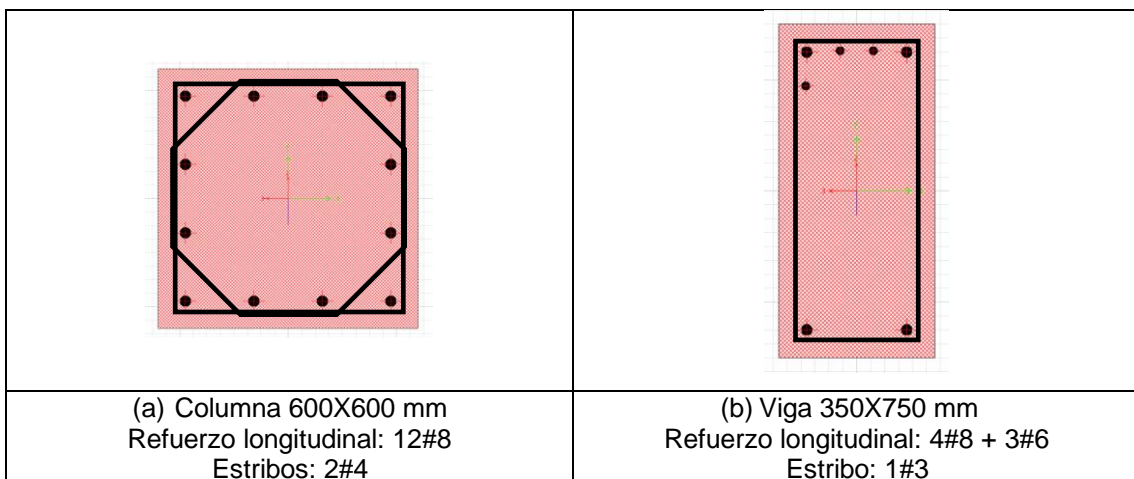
Edificio de referencia: (a) Armadura típica en base de columnas, (b) Armadura en sección V4 en vigas
